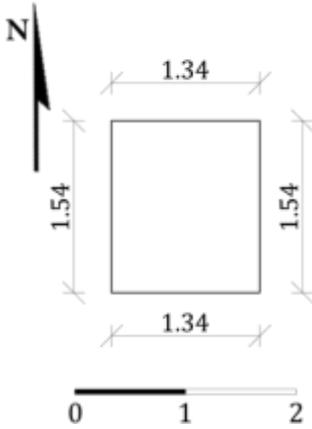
مسقط أفقي للمنور بدهليز المدخل بمدرسة إينال اليوسفي (عمل الباحثة)
